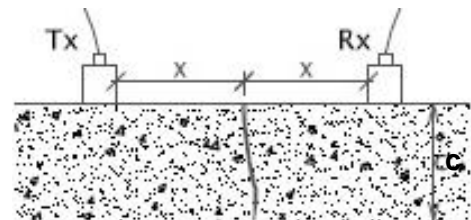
Lectura de la profundidad de fisuras/grietas en el hormigón
